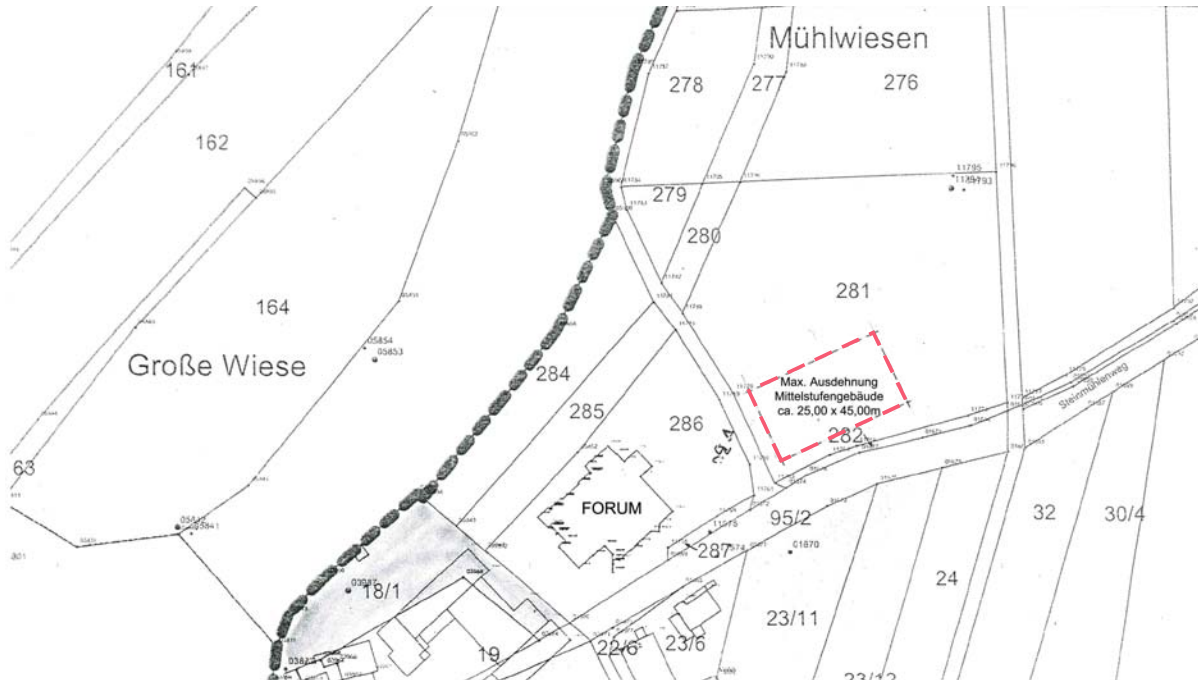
Lageplan mit maximaler Grundfläche des geplanten Gebäudes (o. M.)
